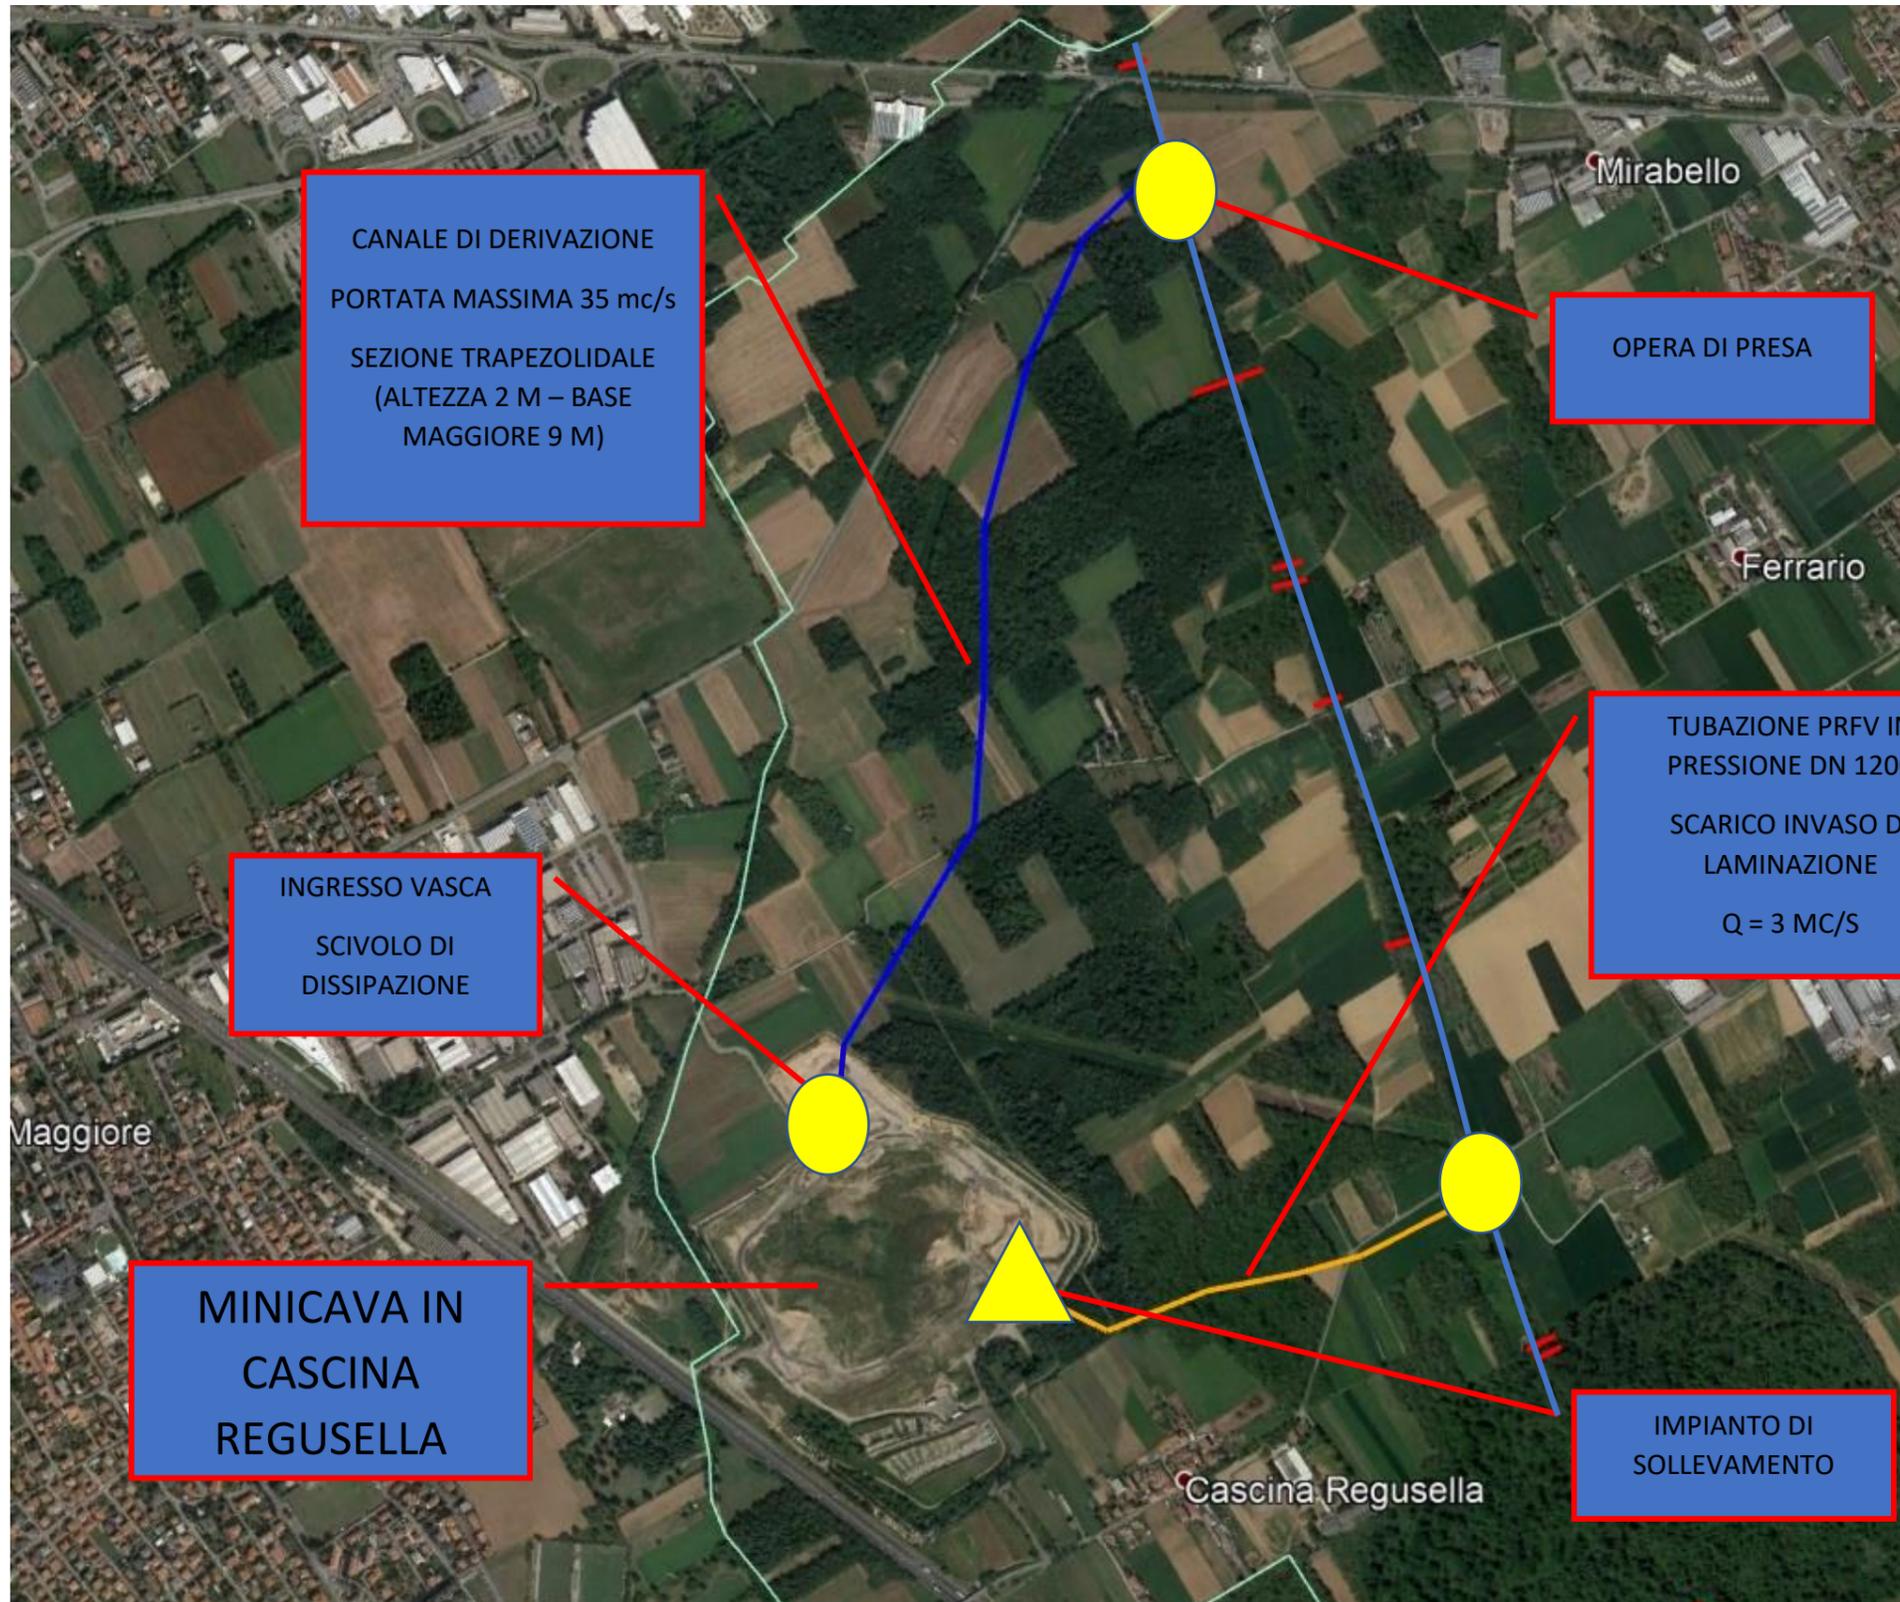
PLANIMETRIA PROGETTO – INVASO DI LAMINAZIONE CAVO REGUSELLA (maggiori dettagli in tavola 1)
